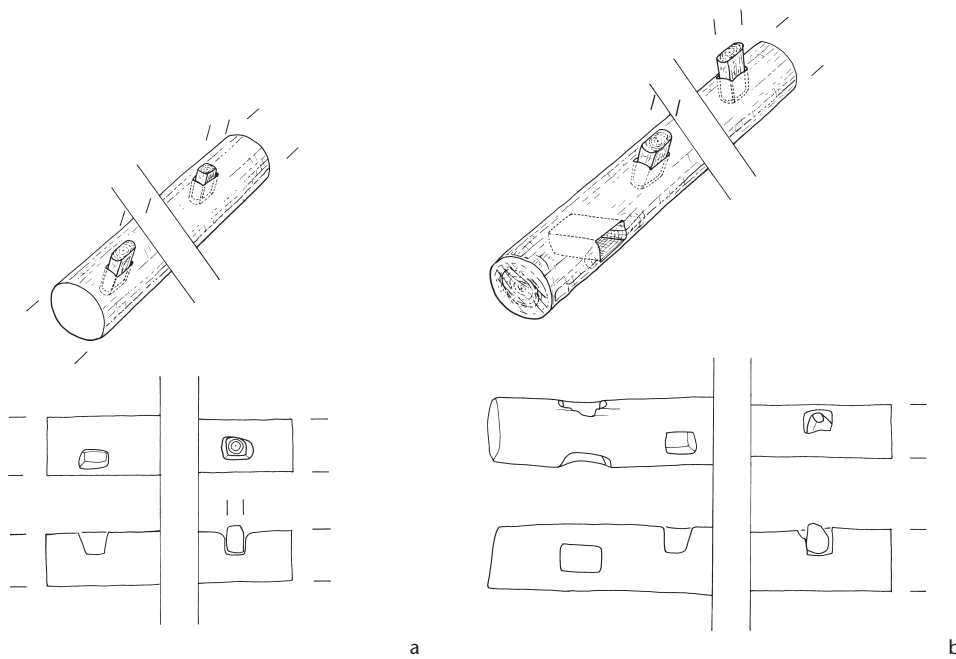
Steinhausen-Chollerpark, US. Schematische Darstellung zur Ausrichtung der Hölzer in den Längsstämmen der Trapeze 2 (a) und 5 (b) auf Grund der Lage der Zapflöcher. M. 1:20.
